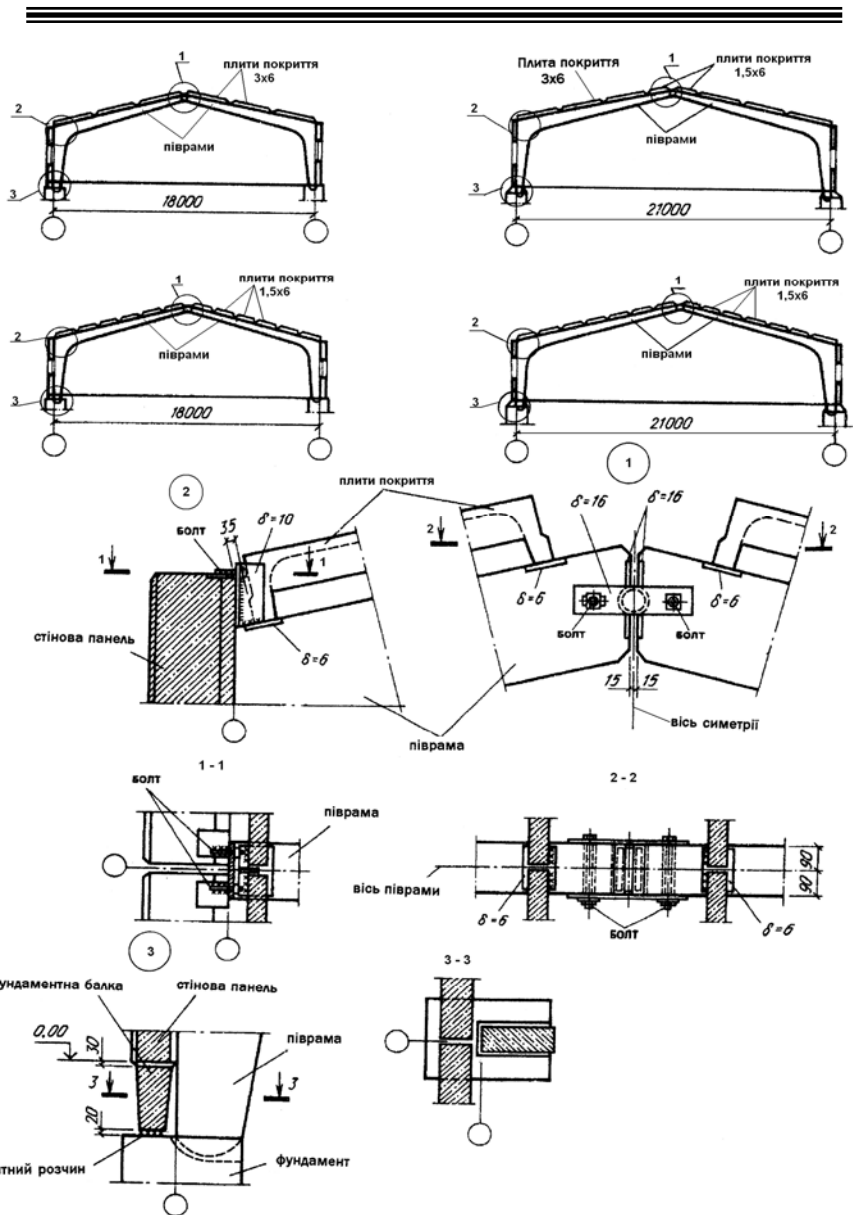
Каркаси будівель із застосуванням залізобетонних рам
